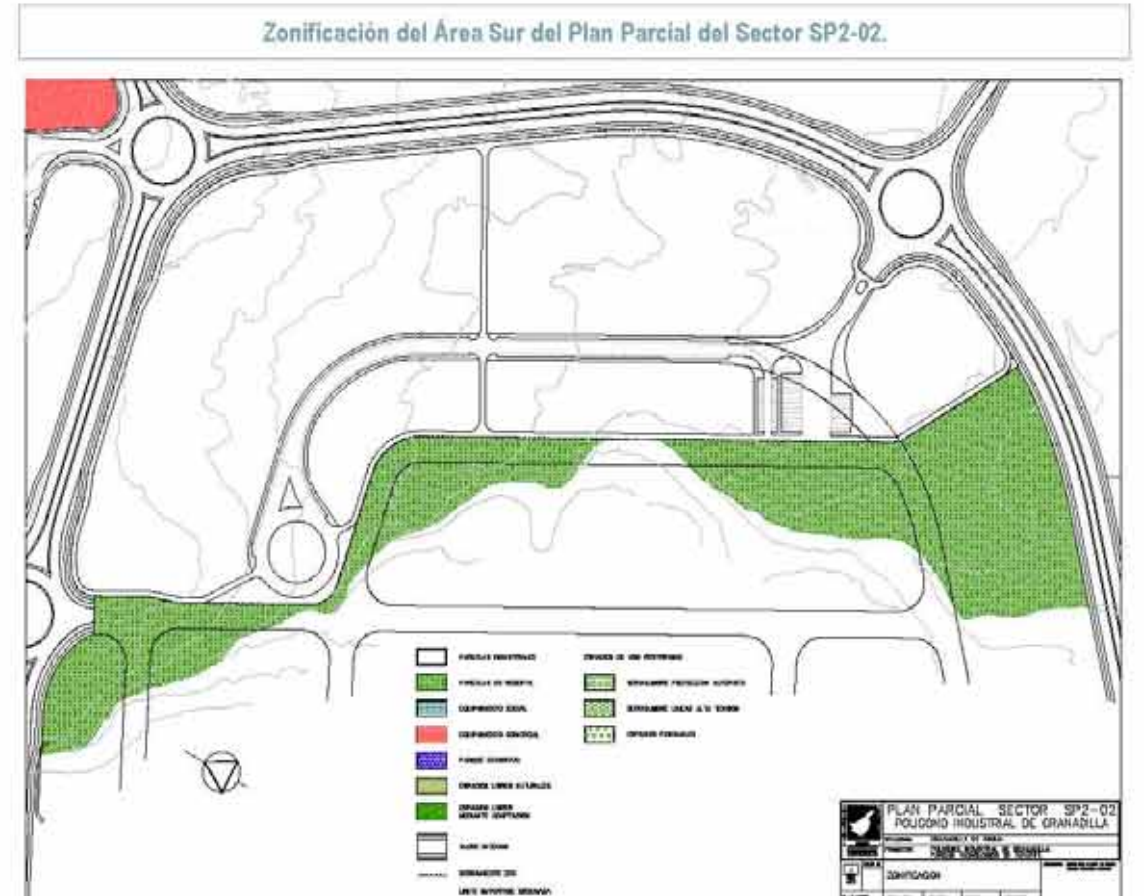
Plano de Zonificación del Suelo del Plan Parcial del Sector SP2-02. Área Sur.
